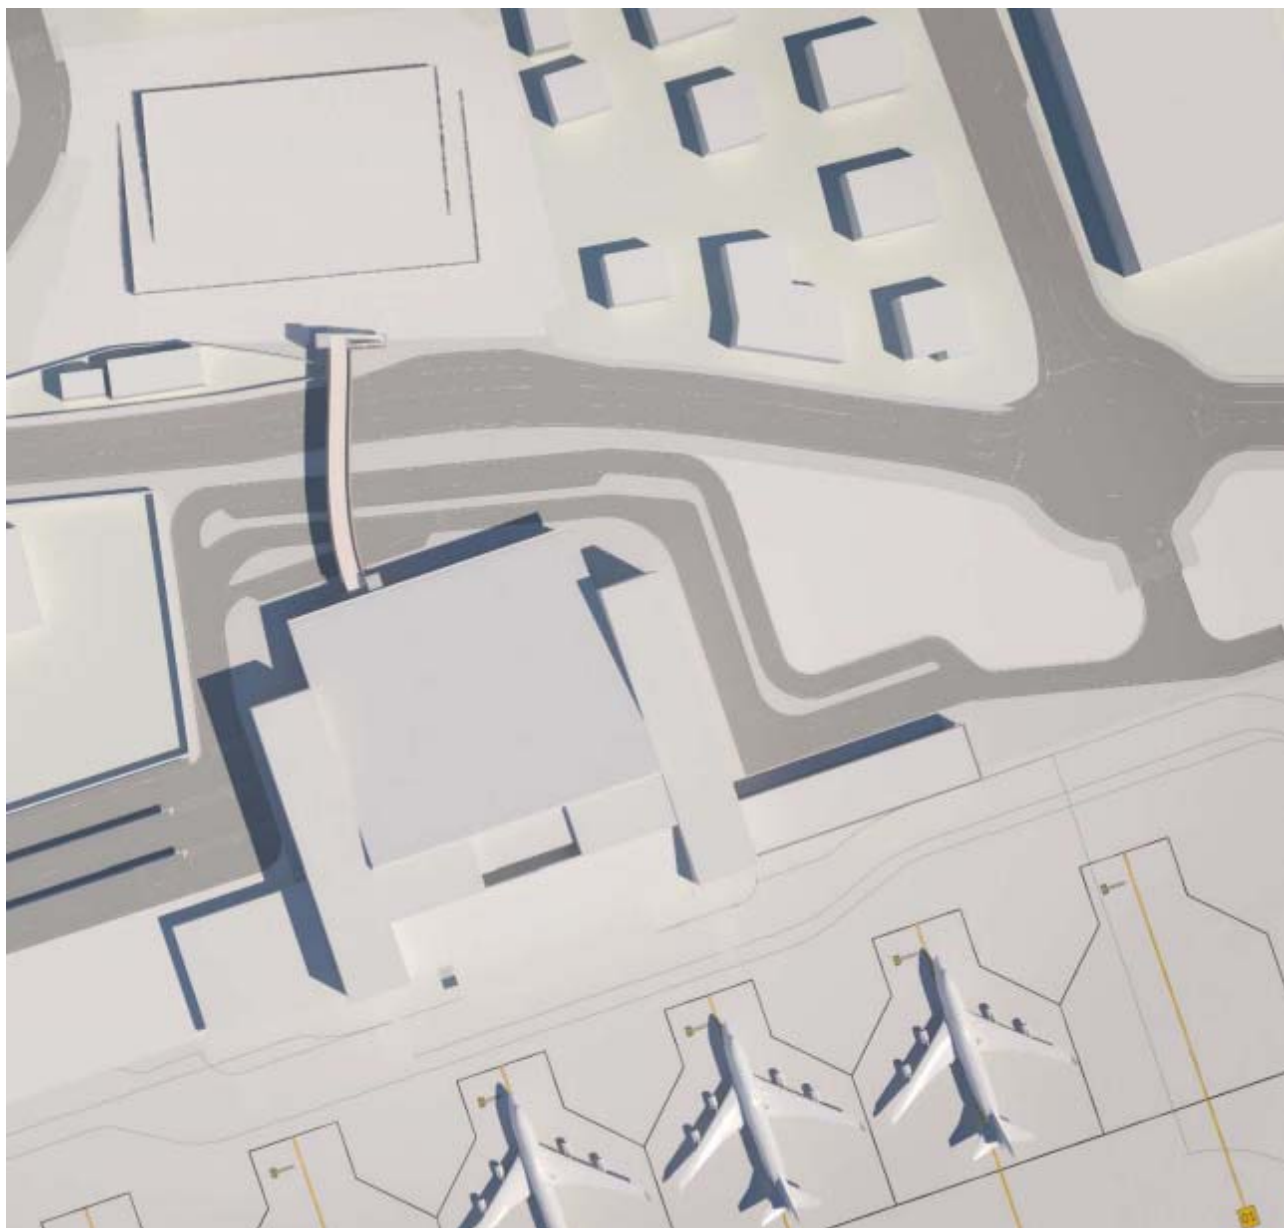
Nuova passerella pedonale che collega il curb al nuovo fast park. Elaborazione One Works
